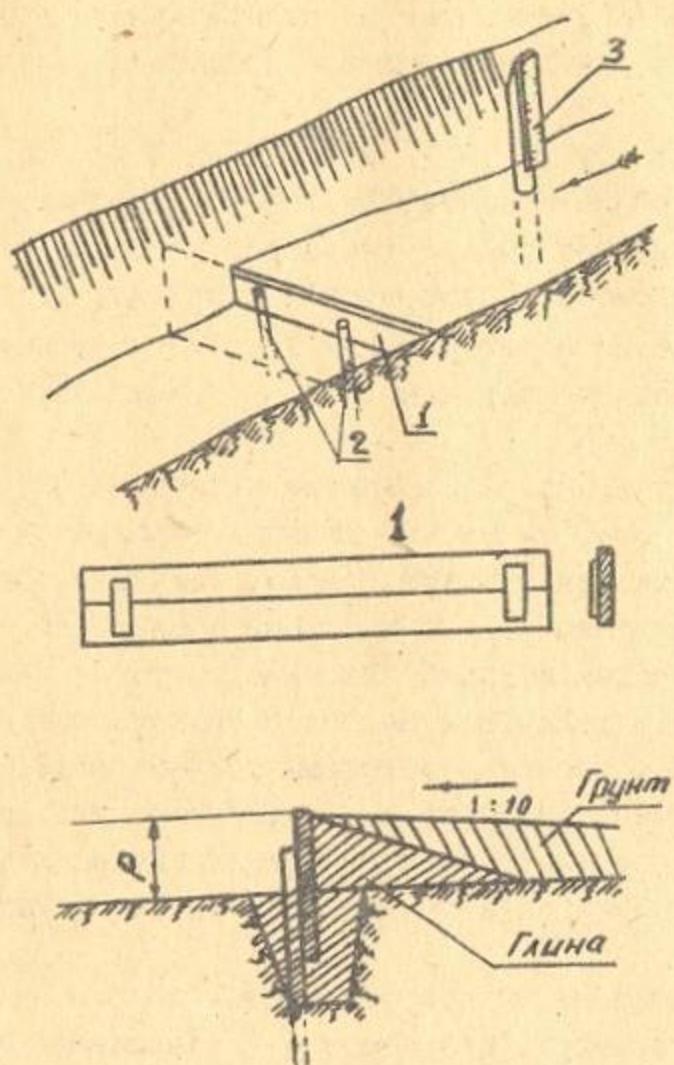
Схема устройства гидрометрического порога в канале: I - стенка порога; 2 - колья; 3 - рейка.
